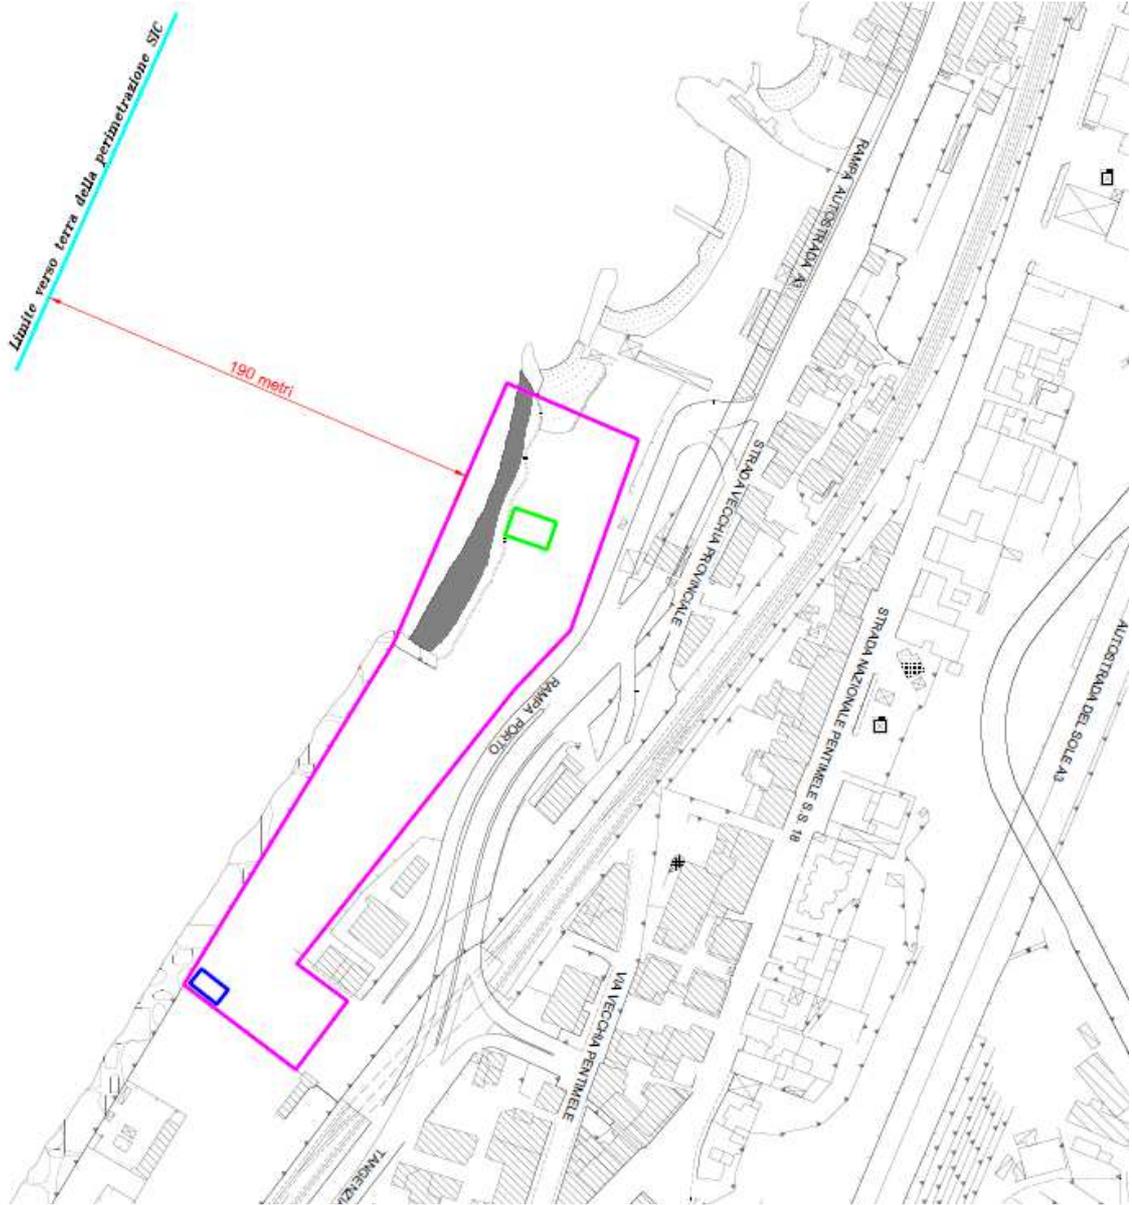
Individuazione planimetrica dell'area di cantiere ed incidenza sul SIC IT9350172
